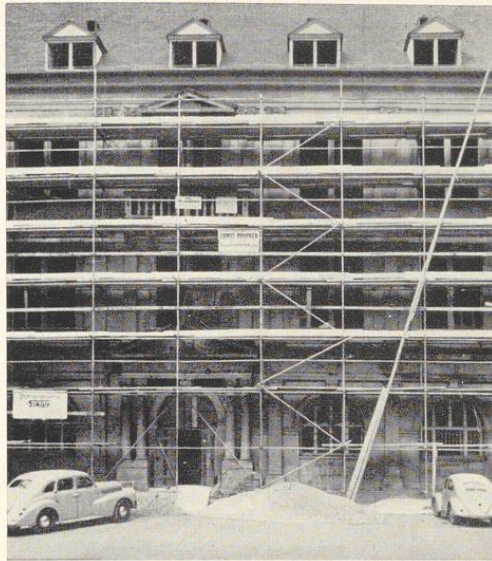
Stahlrohrgerüst mit äußerem Leitgang
